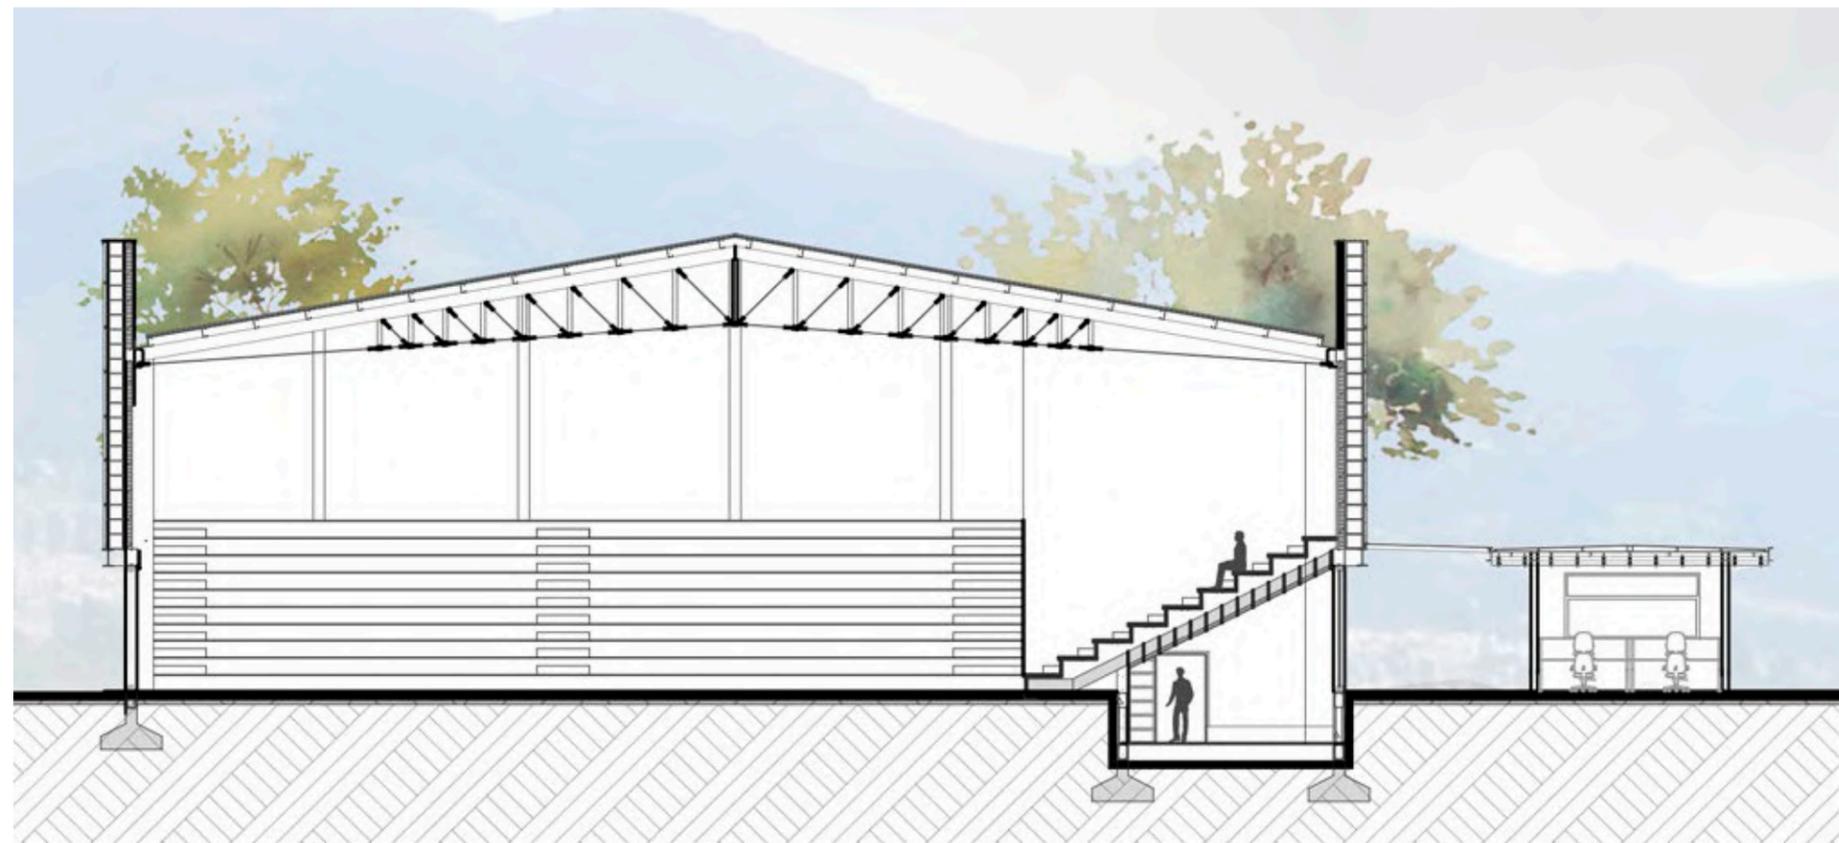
| Sección general del coliseo | Fuente: Elaboración Propia
